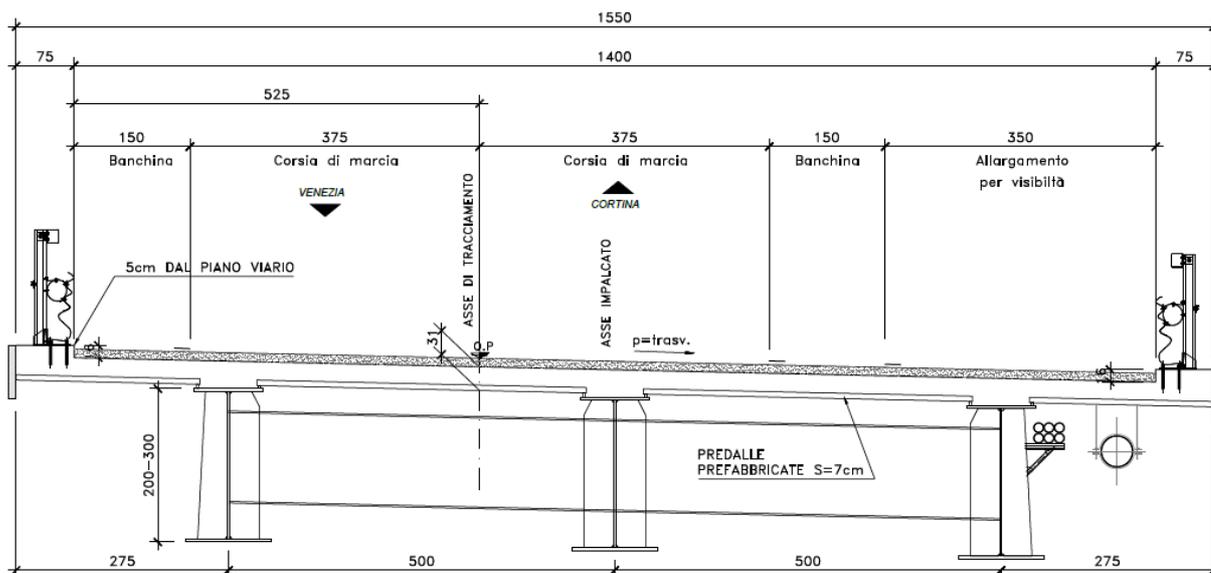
Sezione trasversale impalcato tra pila P2 e spalla SPB.
